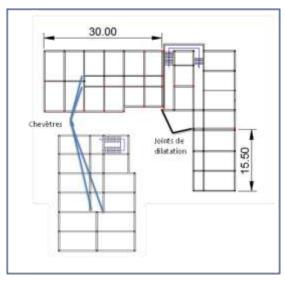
Plan de structure des blocs A et B Source: photo /auteurs.
